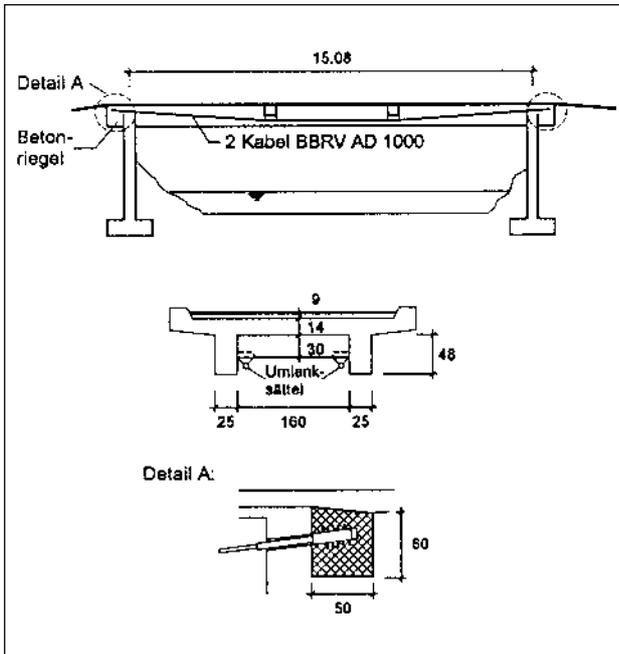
Eintragung von Zugkräften durch Anker in bestehenden Beton (Jungwirth et al, 1986)
